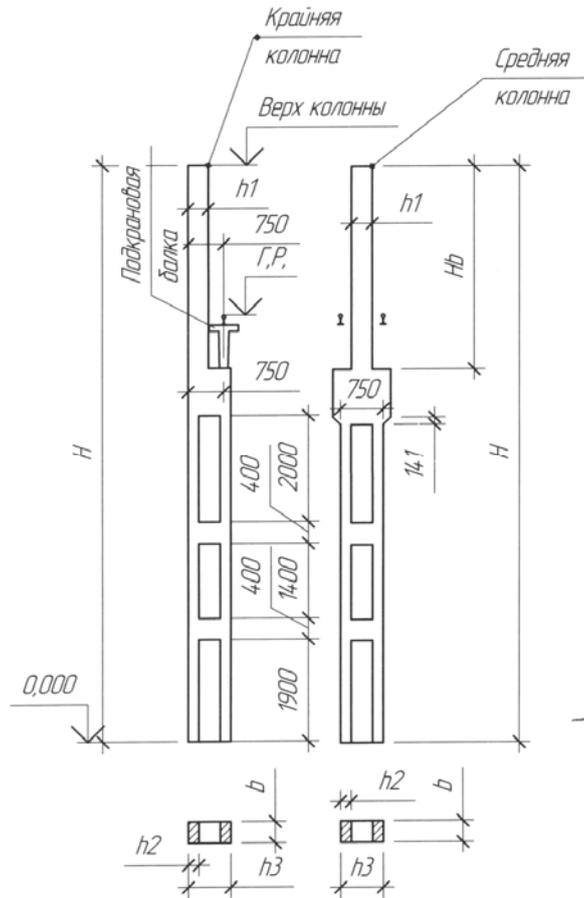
Конструкция двухветвенных колонн для зданий с мостовыми кранами
